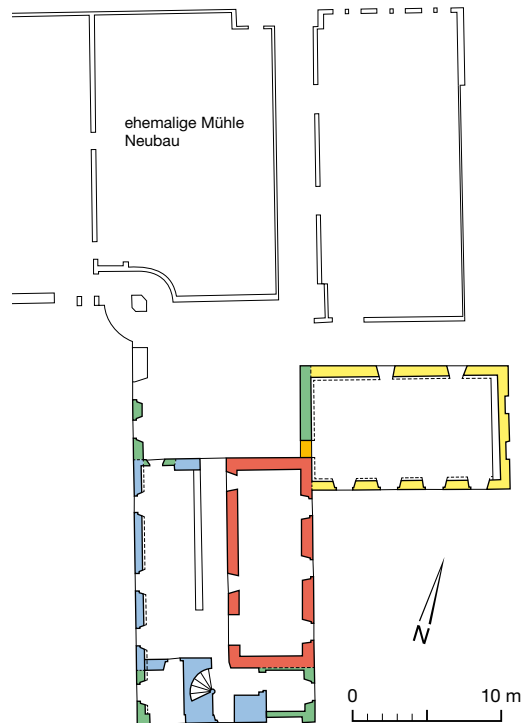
Konolfingen, Schloss Hünigen. Übersichtplan zum Erdgeschoss mit der Gliederung der nachgewiesenen Bauphasen. M 1:500.
